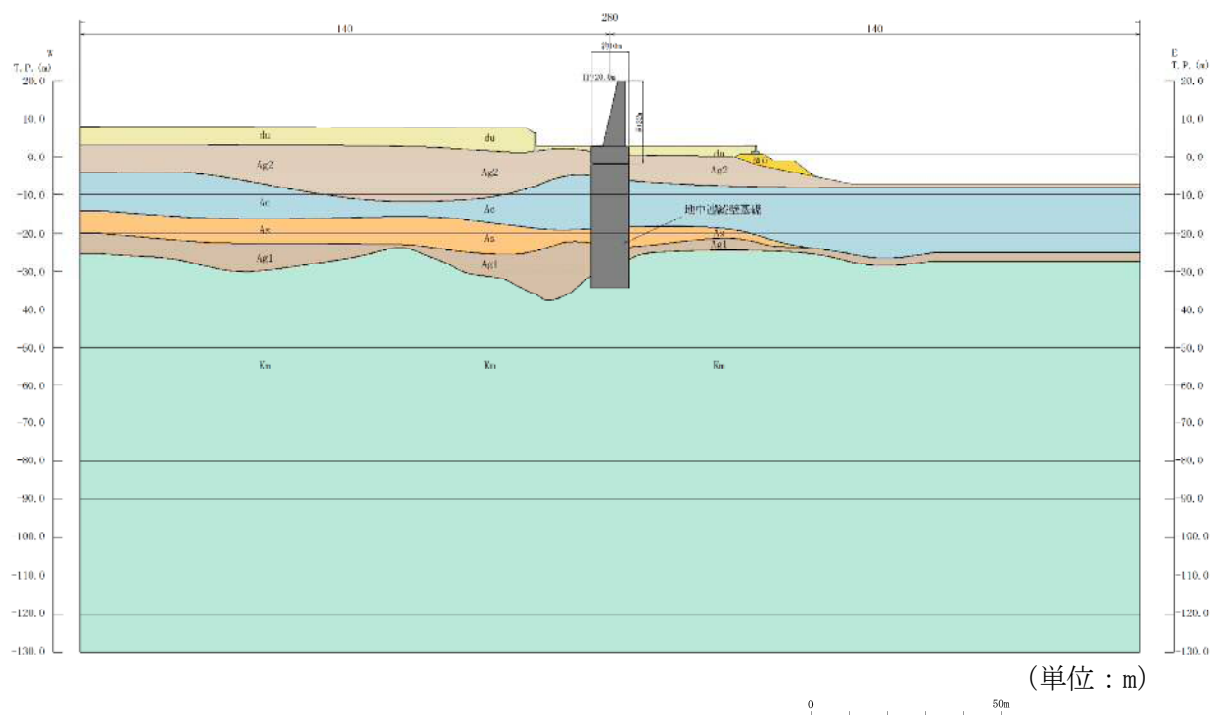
(4) 鉄筋コンクリート防潮壁 断面図(D-D断面)
